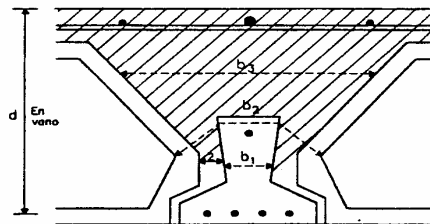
Comprobación de esfuerzo cortante en nervios de forjados de vigueta pretensada
